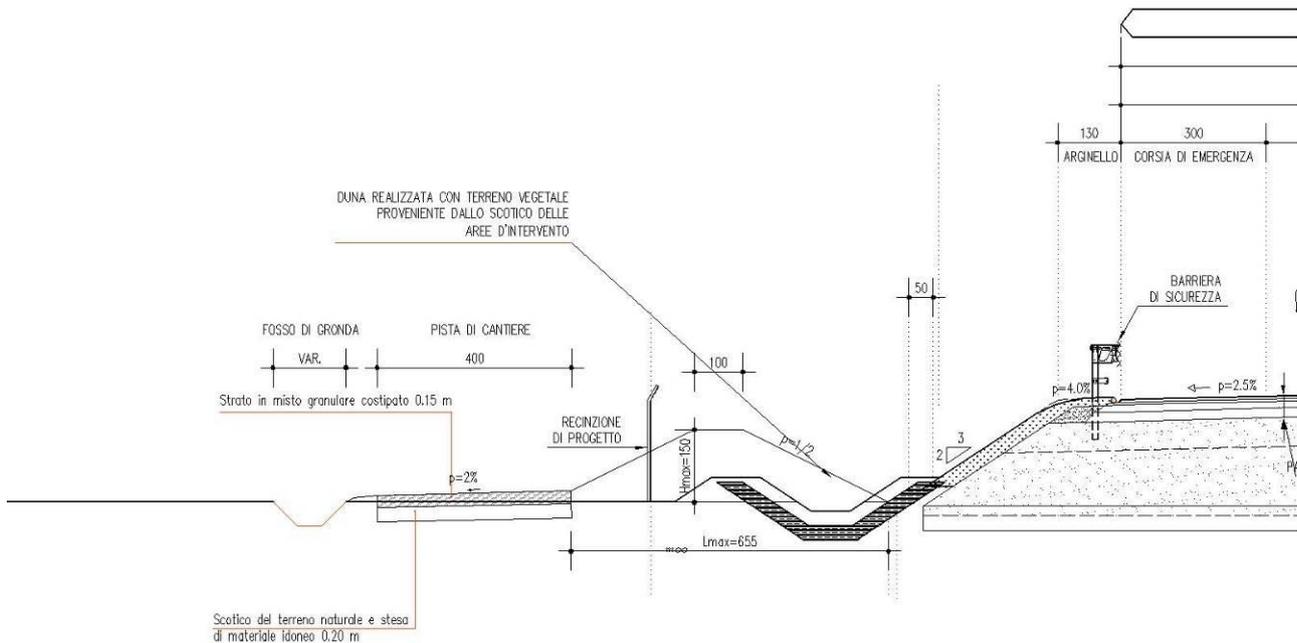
SEZIONE TIPO DELLE PISTE DI CANTIERE (ESTRATTO DALL'ELAB. PD_0_000_0KK00_0_KK_SH_01)
